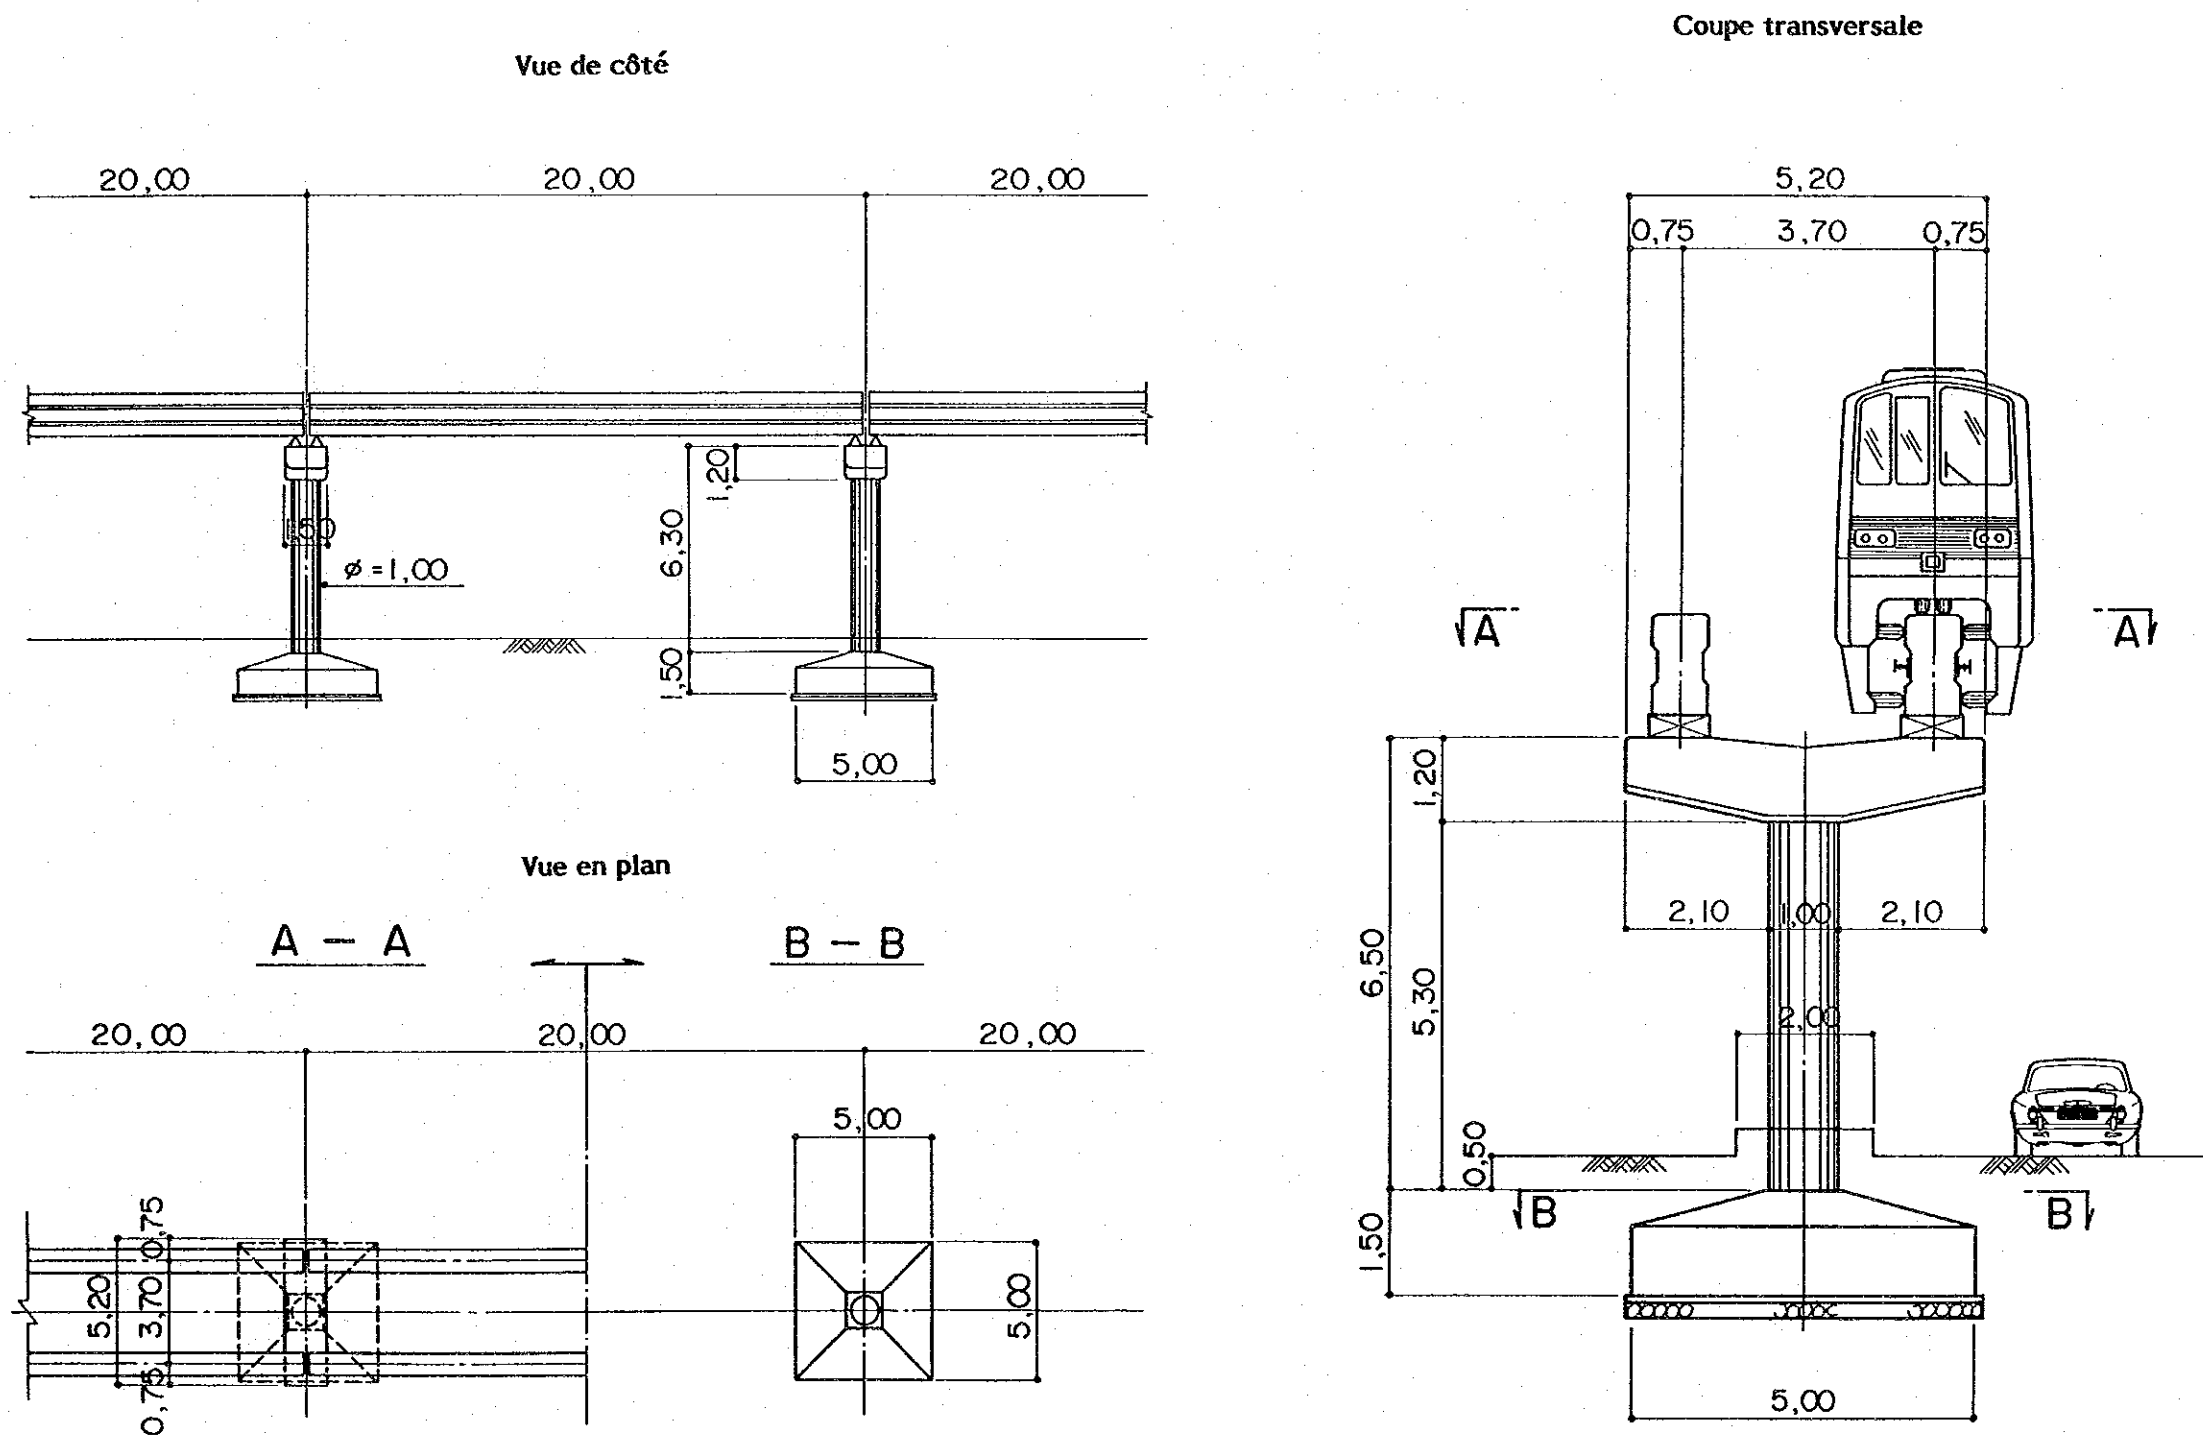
Ouvrage surélevé standard (monorail sur poutre)
